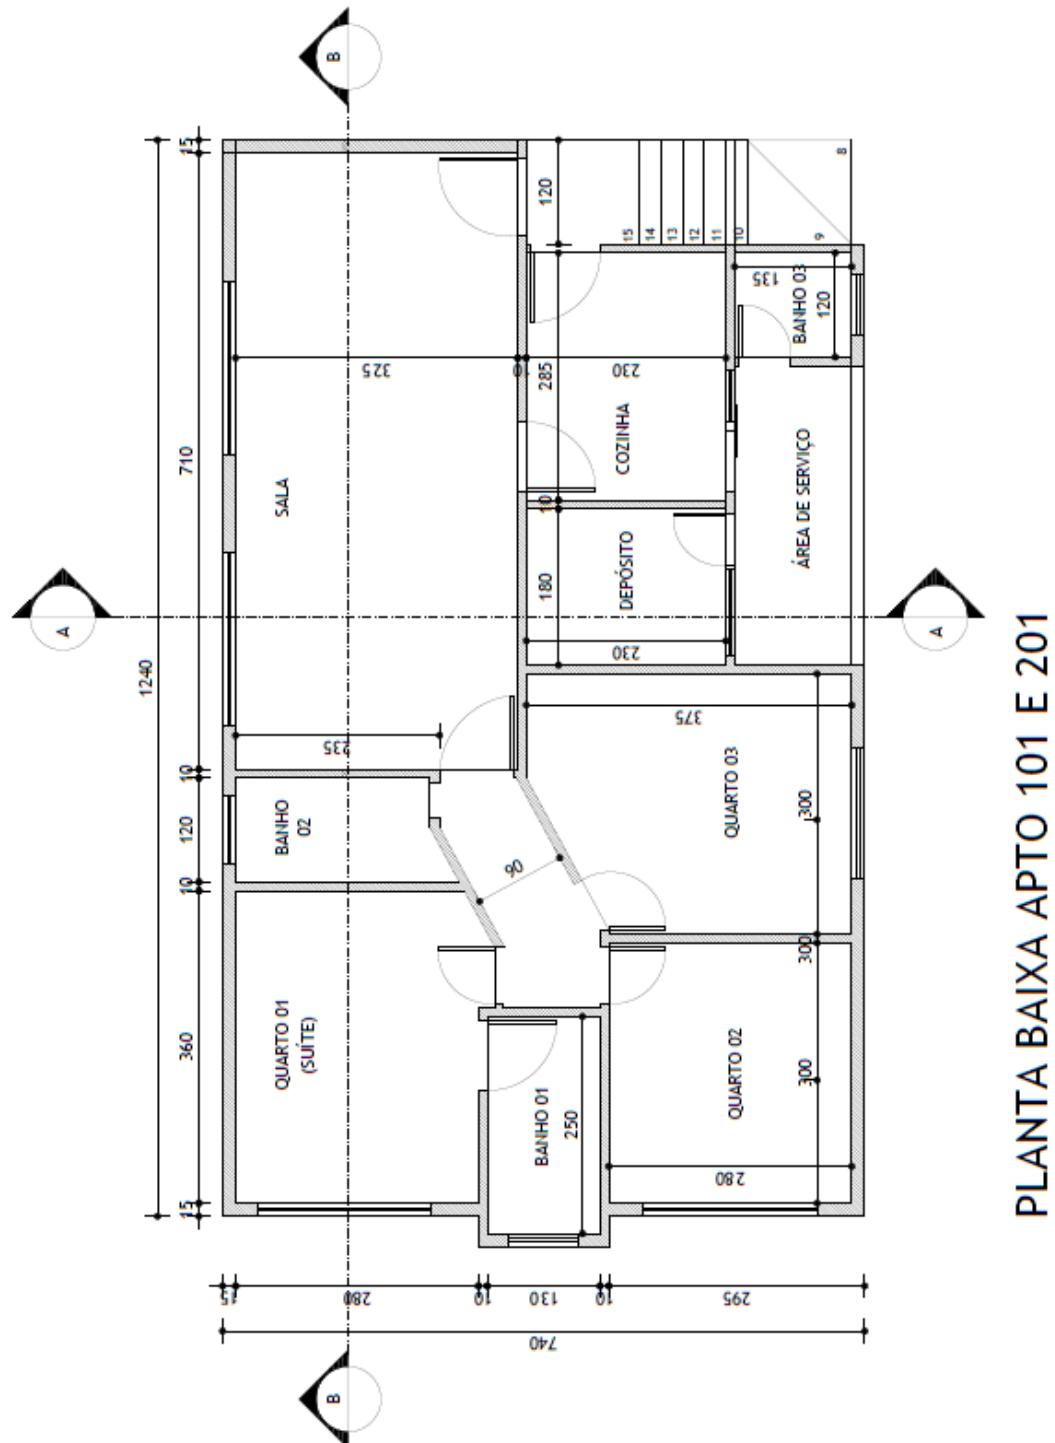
Planta Baixa dos apartamentos ensaiados
